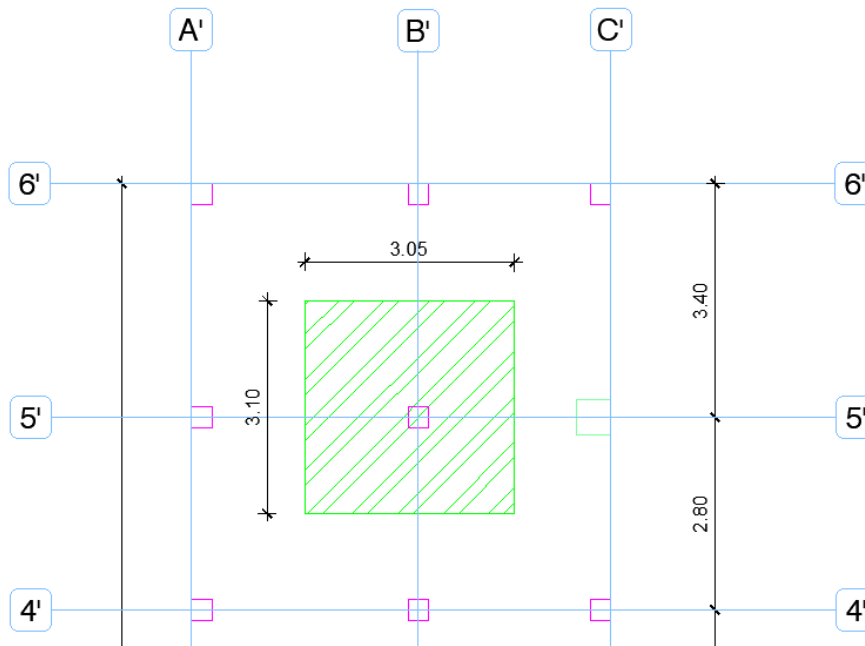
Vista en planta de la columna a predimensionar [Fuente: Loa autores]
